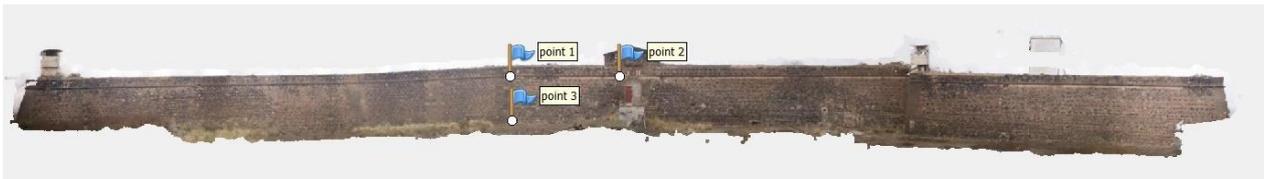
Fotoplano de la fachada este. Elaboración propia
